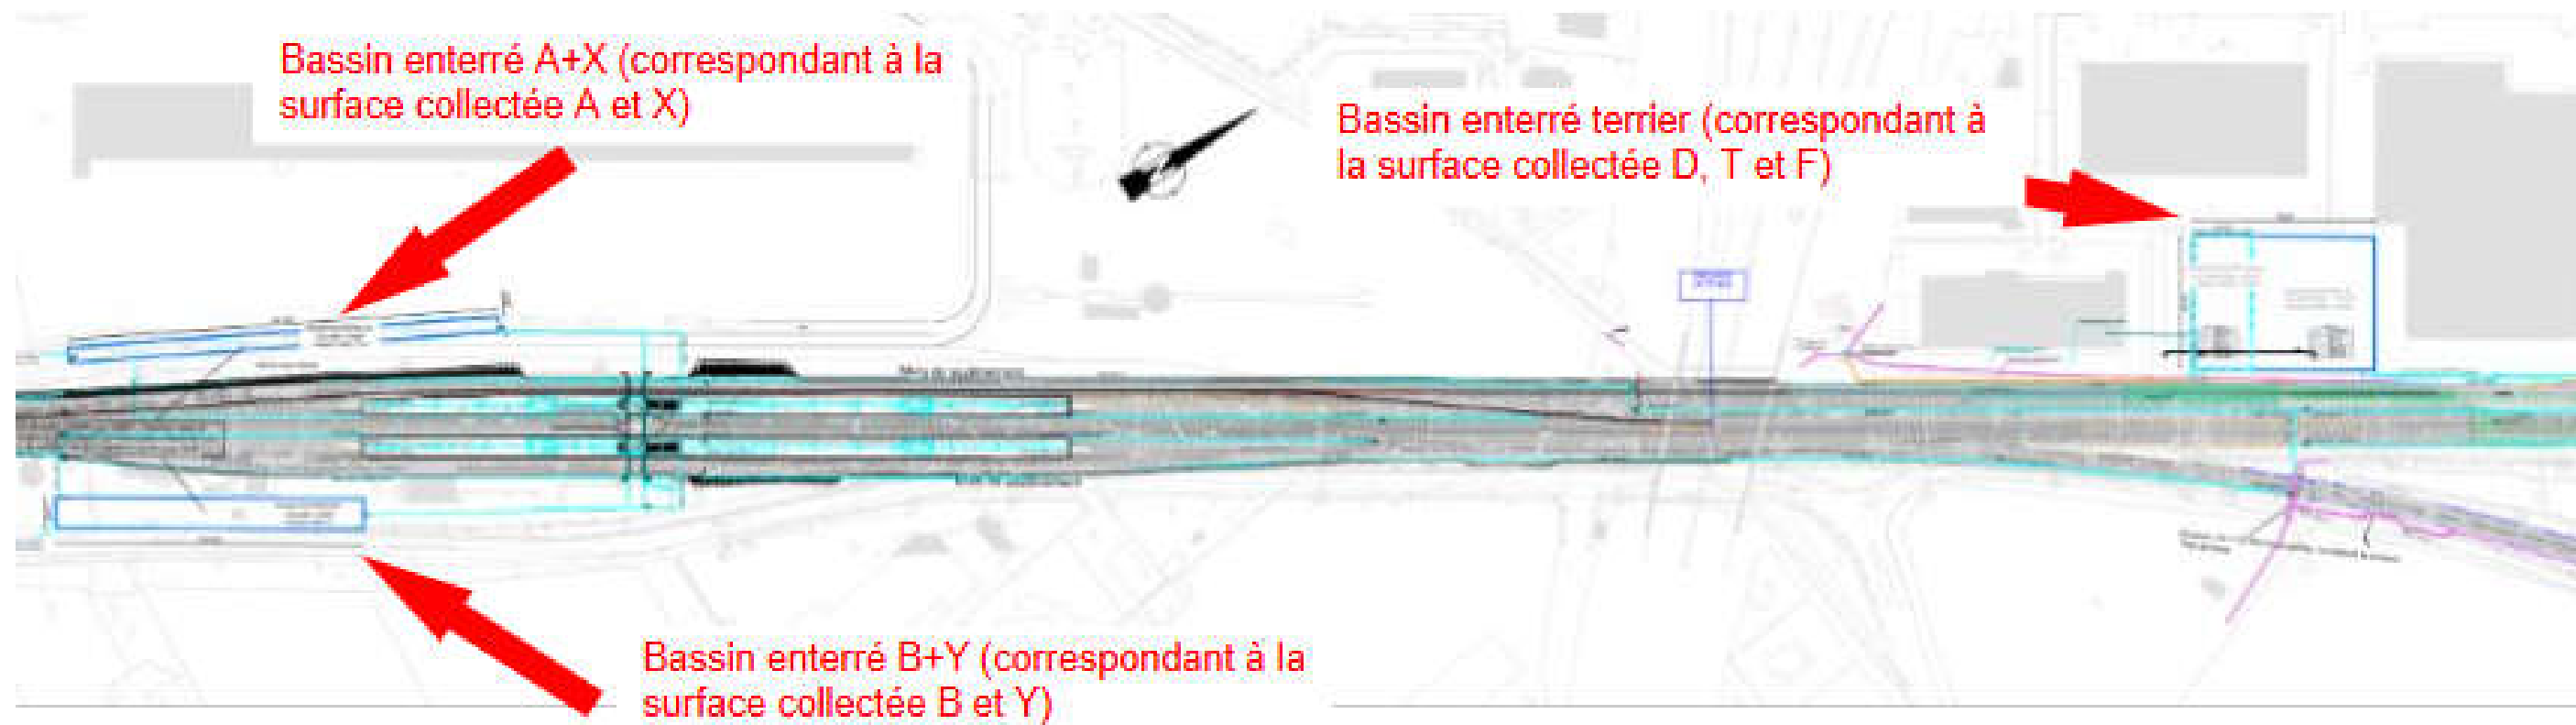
Vue en plan de l'implantation des ouvrages d'assainissement
